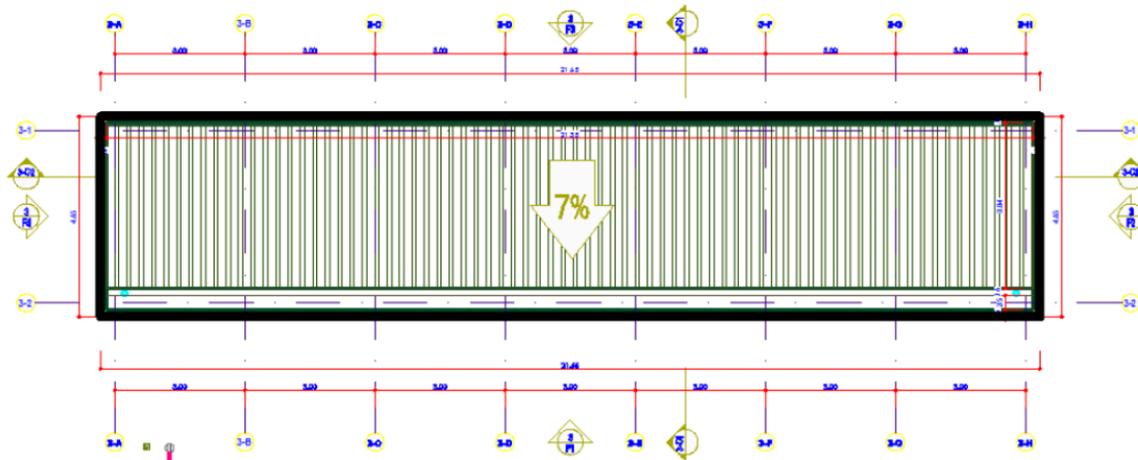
Planta de Cubierta Centro de acopio. Unión temporal SENA (2019).
